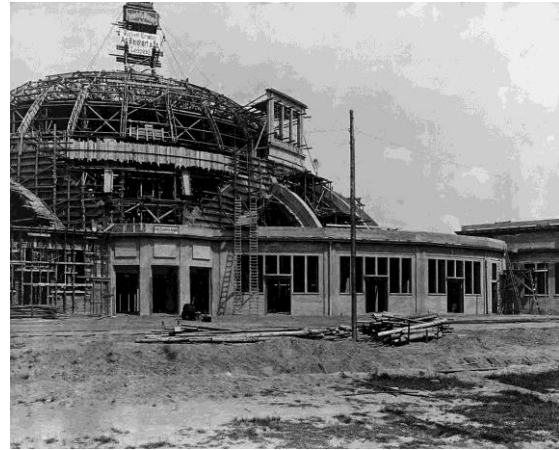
(re.): Bauausführung: Rundgang tlw. im Rohbau fertiggestellt; Kuppelgerüst mit Fassaden-Muster
